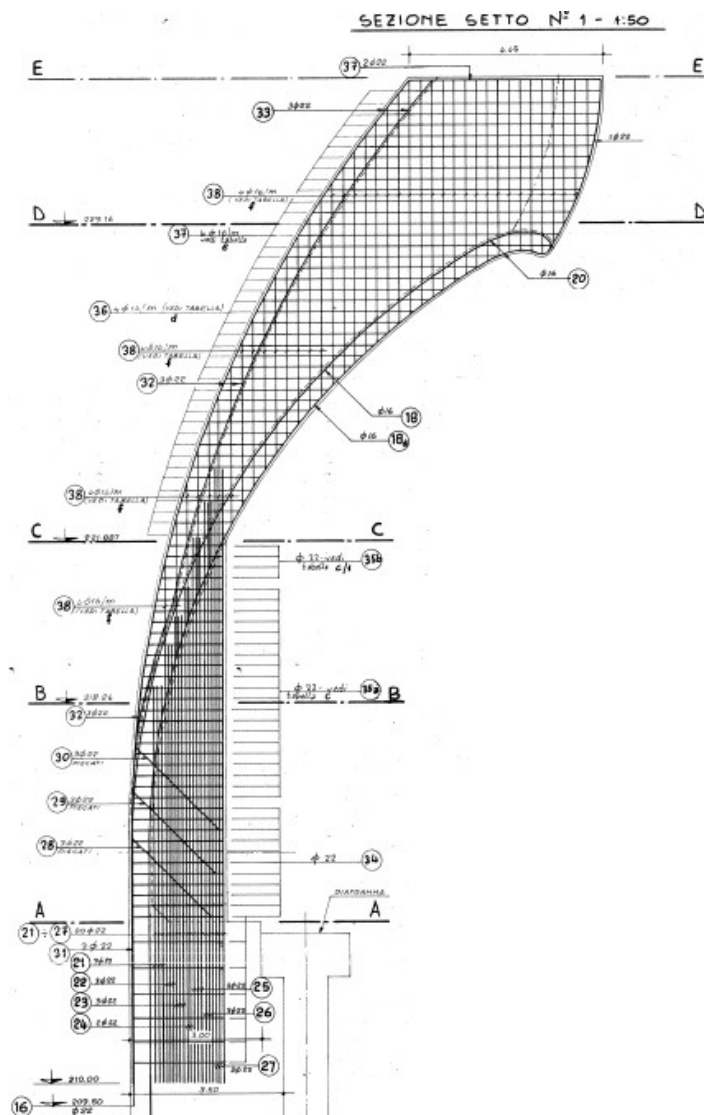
Armature nei setti antivortice e nelle nervature – Vista in sezione
